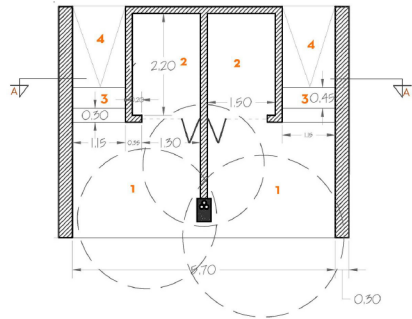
Plano de planta de un prototipo de unidad de mercado
